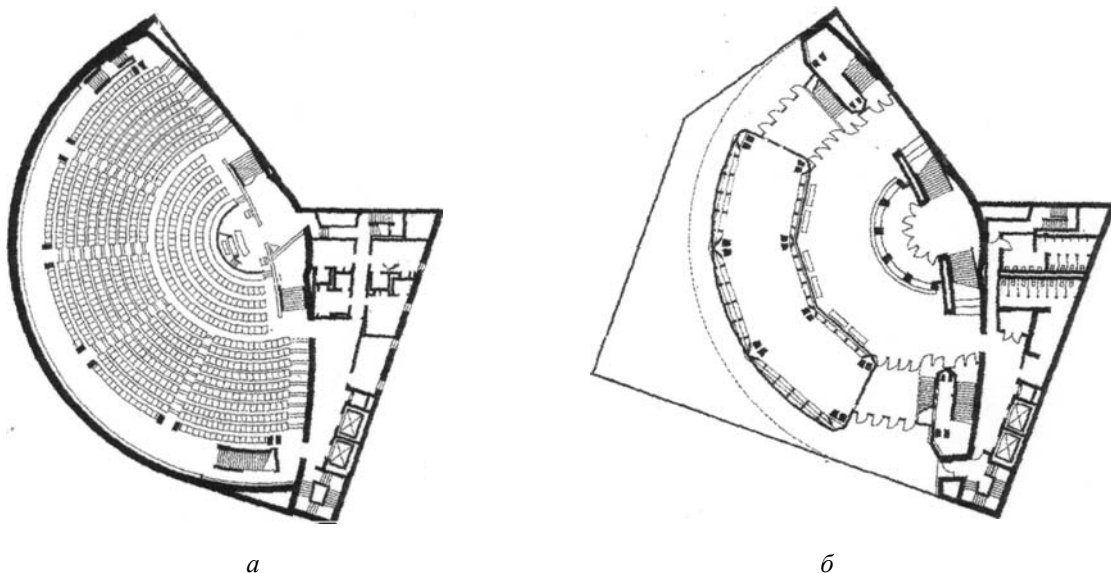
Церква в Чикаго: а – план 1-го поверху; б – план 2-го поверху
